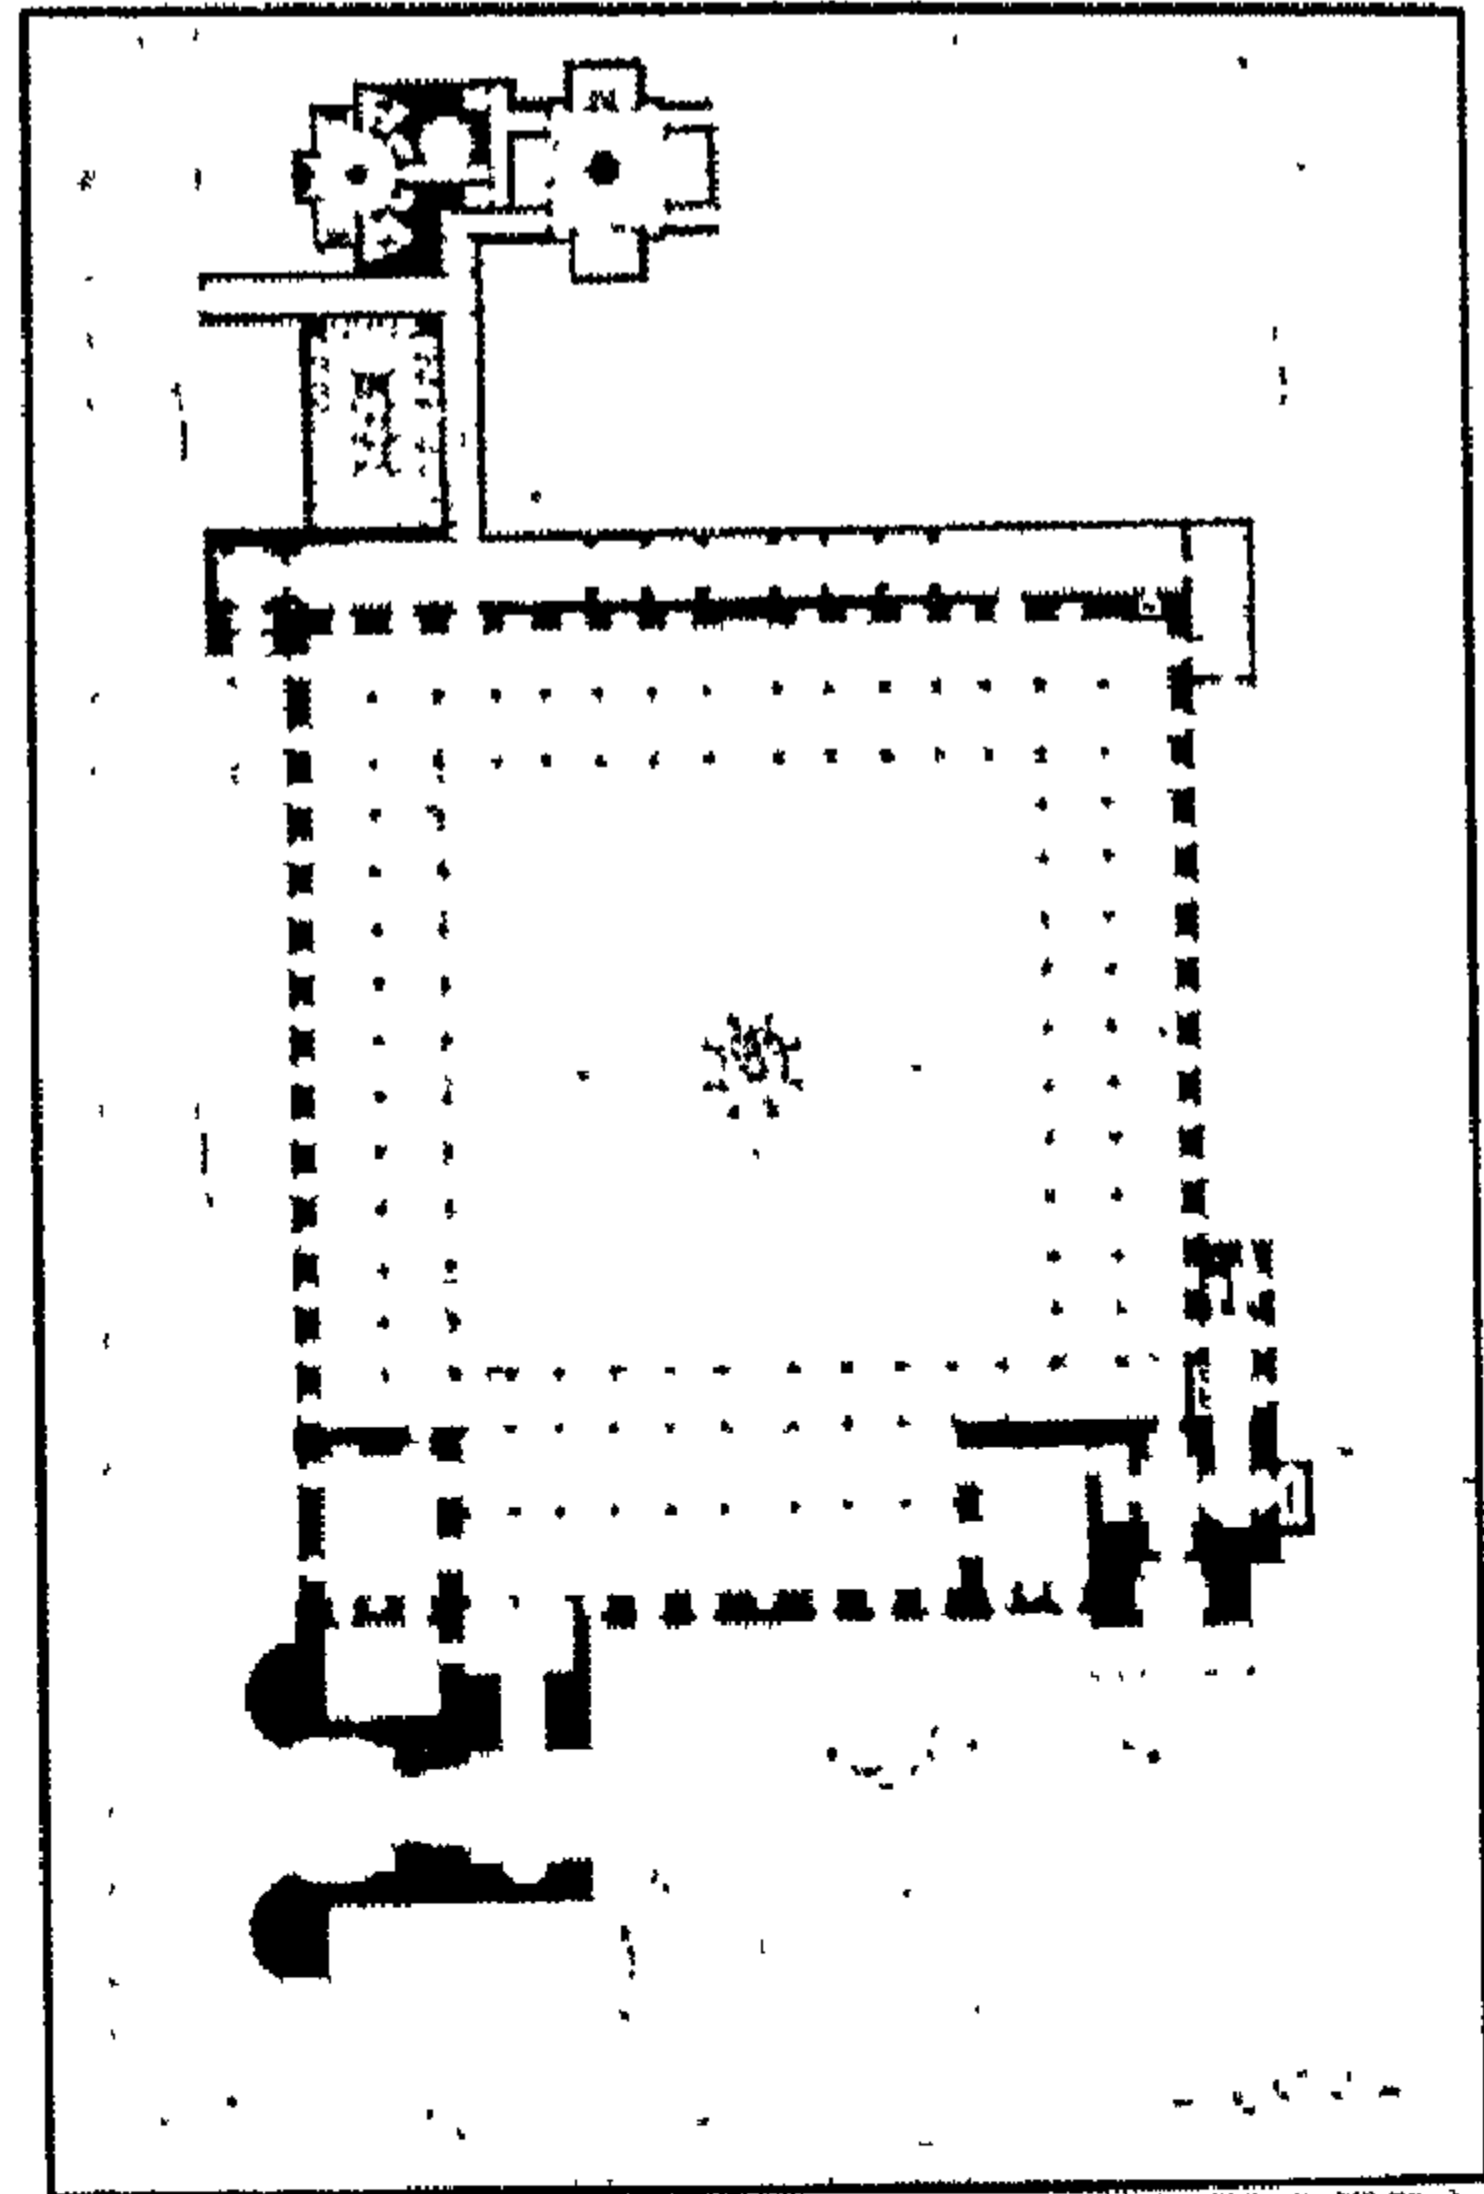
جامع سامراء (مسقط أفقي) عن : كريزول
